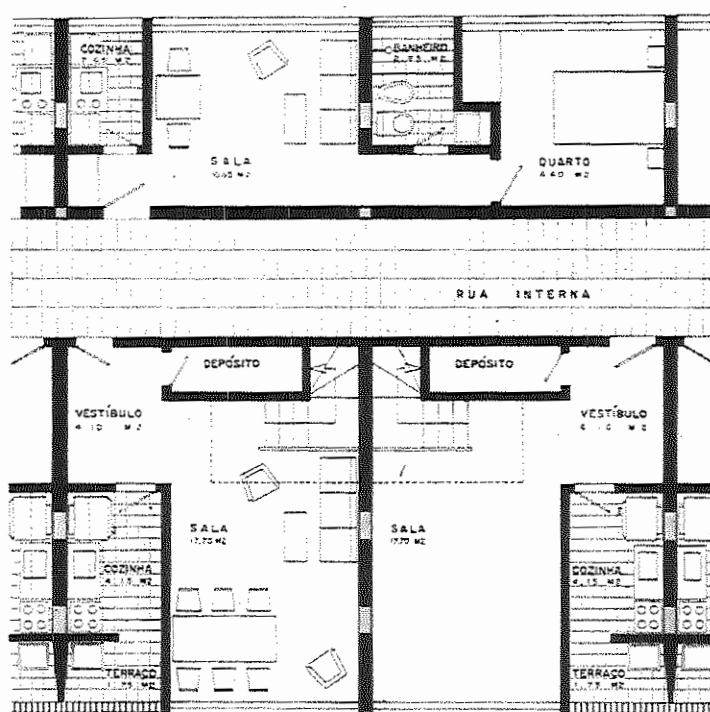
Piso inferior do apartamento dúplex do bloco horizontal
